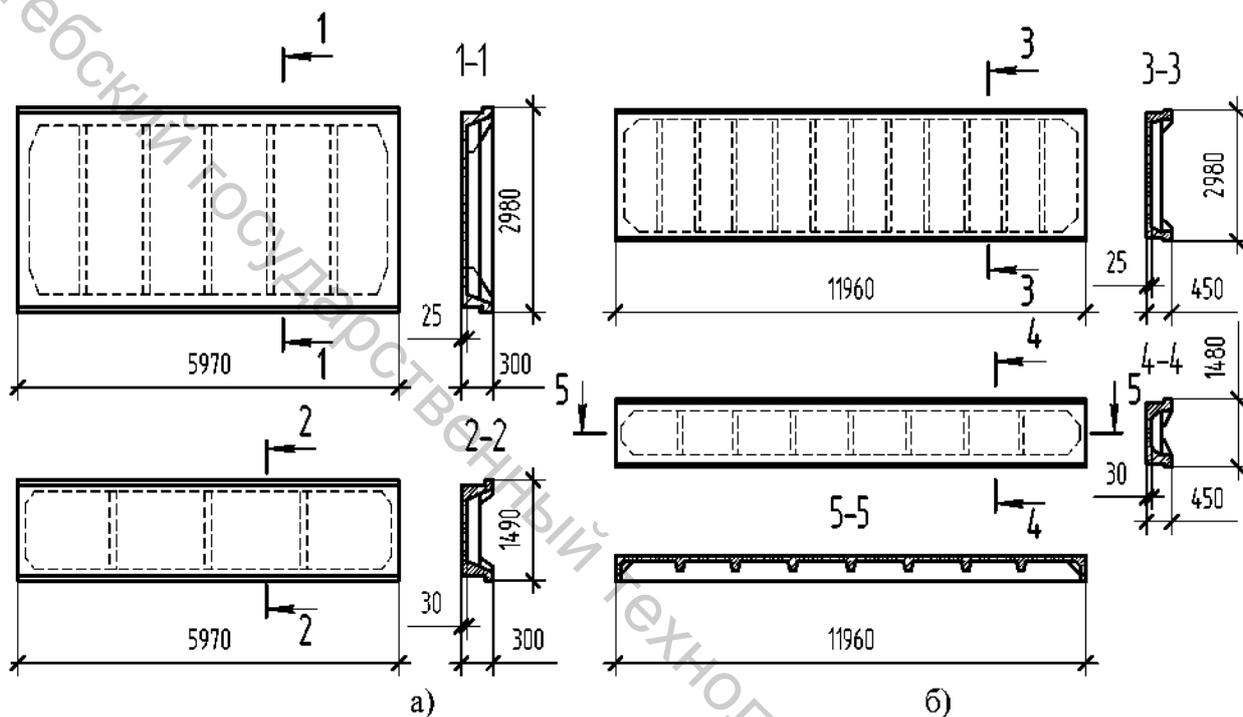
Железобетонные плиты покрытий: а – ребристые размером 3×6 и 1,5×6 м; б – то же, 3×12 и 1,5×12 м
